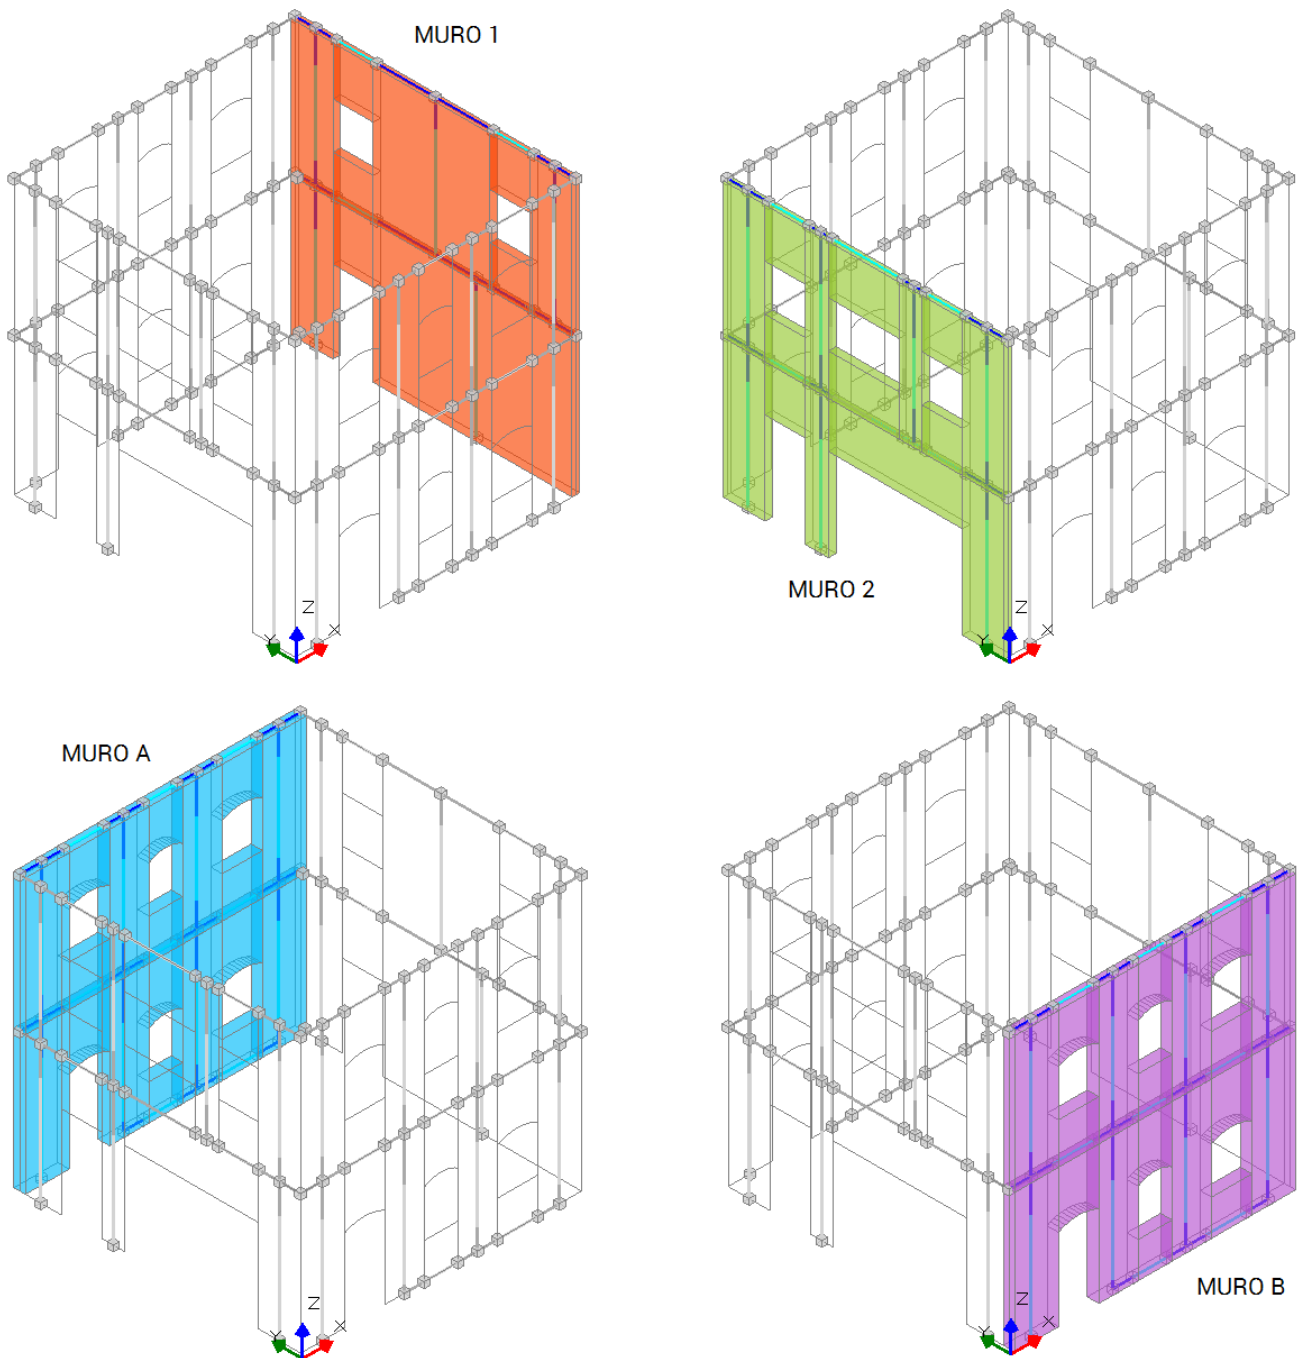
Modellazione 3D dell'edificio: i 4 paramenti murari 1,2,A,B
